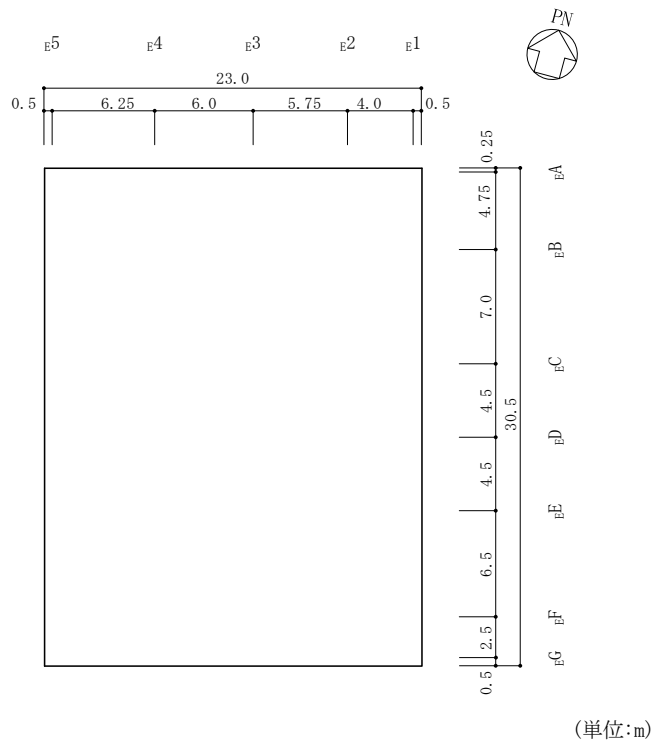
(2) 緊急時対策所の概略平面図 (EL 56.6m)
